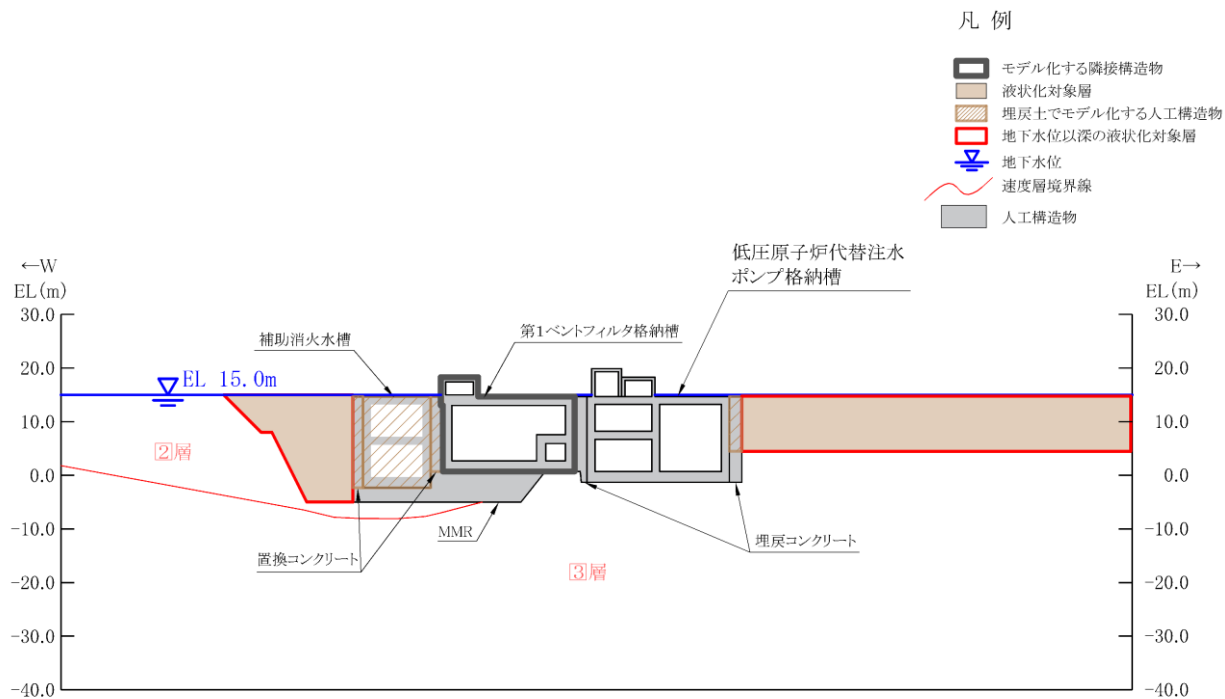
低圧原子炉代替注水ポンプ格納槽 評価対象断面図 (B-B 断面位置)
